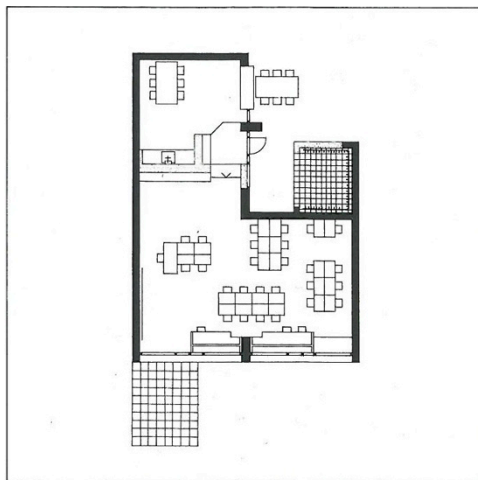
Grundriss eines Klassenraums [Links oben] (LÜCHINGER 1987, 55)
